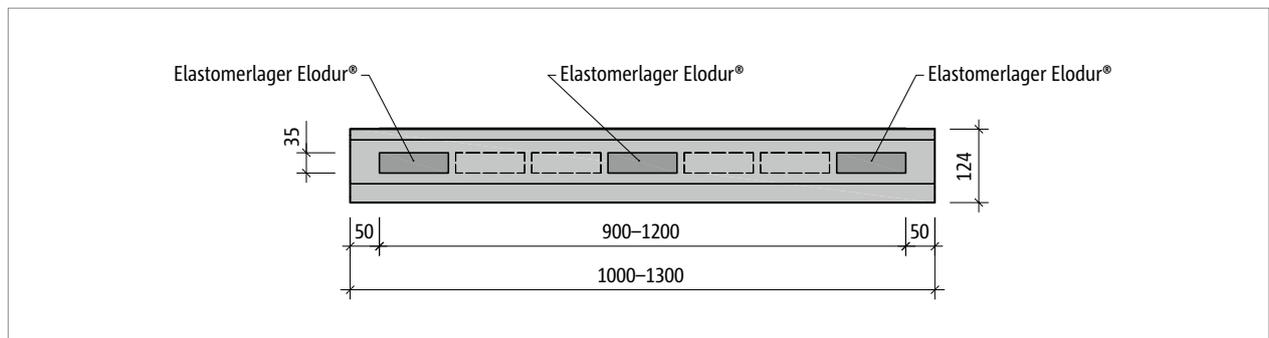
Schöck Tronsole® Typ F: Grundriss
